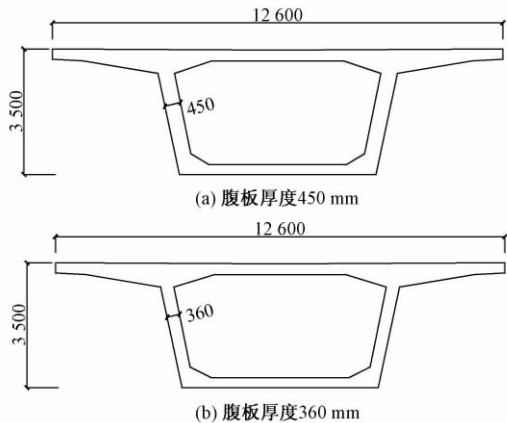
跨度 40 m 简支梁跨中截面示意(单位:mm)
